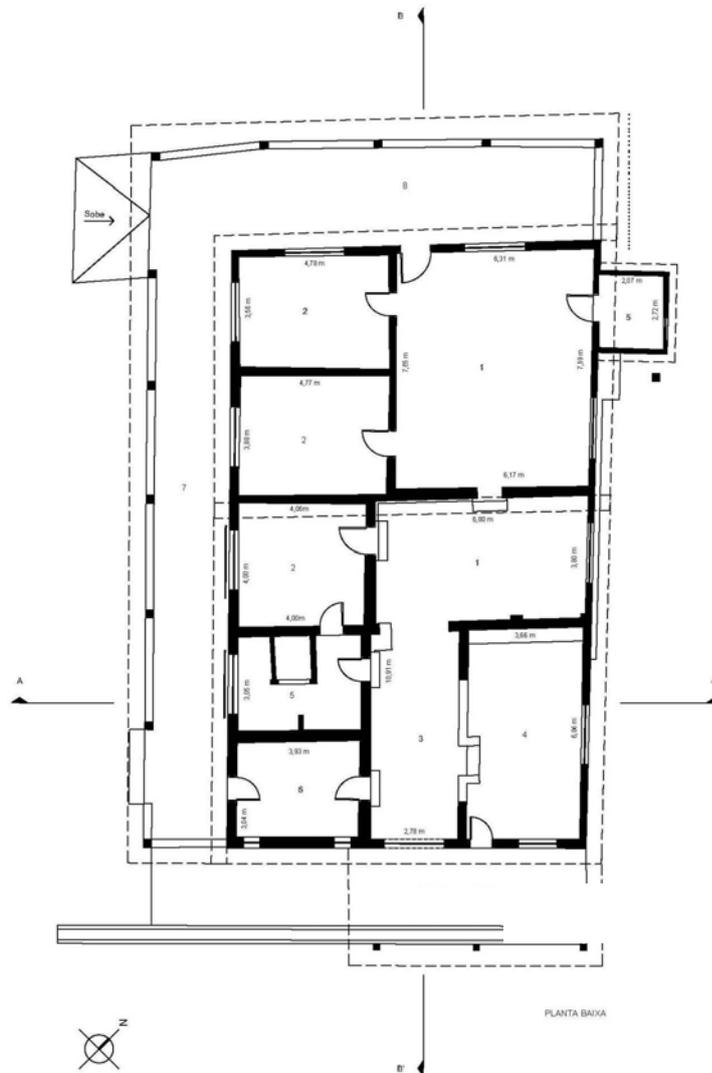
Planta baixa da casa da Fazenda Desterro. Área do Núcleo Básico de 84,53 m²; Área total de 226,63 m² (Acervo PROAU/FAU/UnB).
